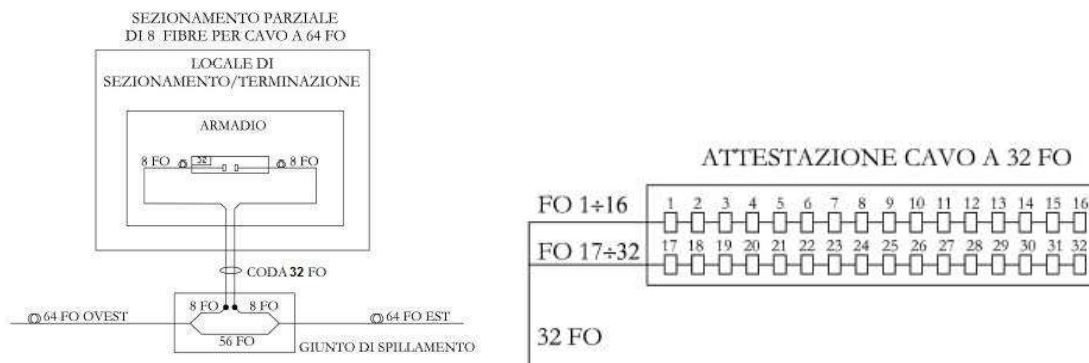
sezionamento parziale cavo 64 FO (sx) e attestazione cavo 32 FO (dx).
